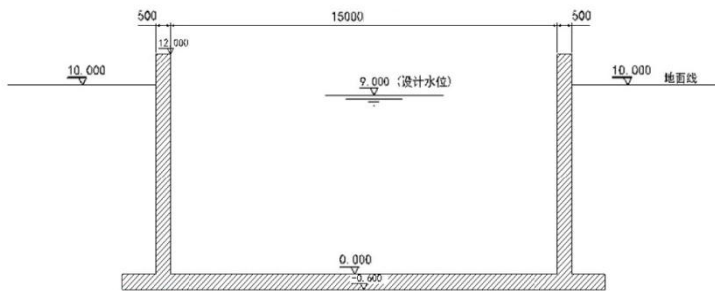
水池断面布置图（单位：标高：m；长度单位：mm）
